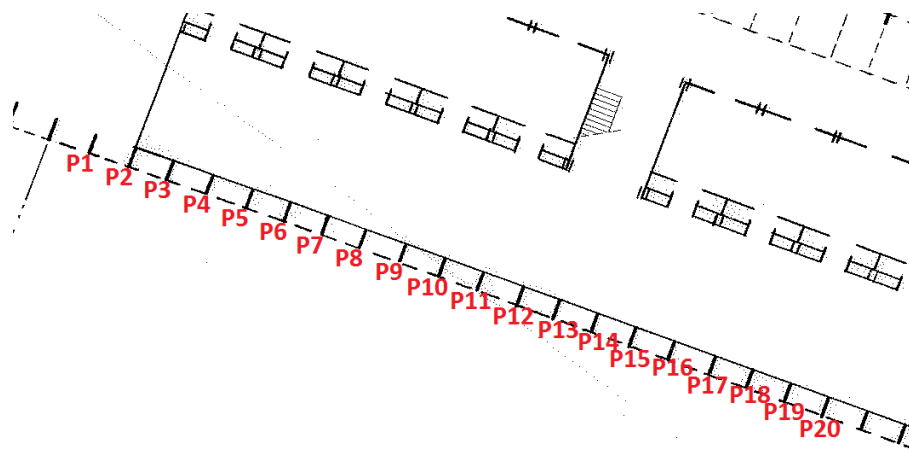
Recorte e numeração dos pilares da fachada externa – Ala leste do Bloco A.
